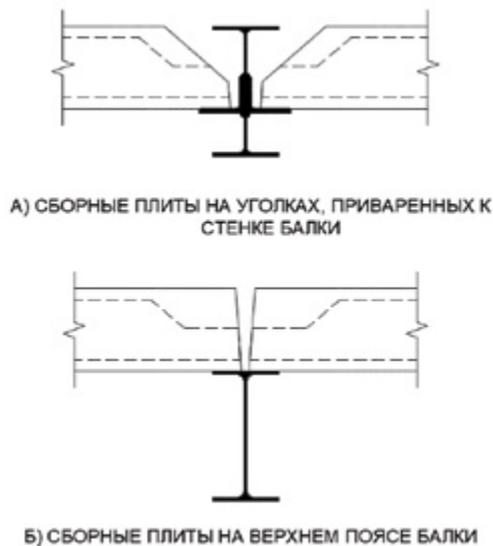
Варианты устройства перекрытий из сборных плит без совместной работы со стальными балками.
